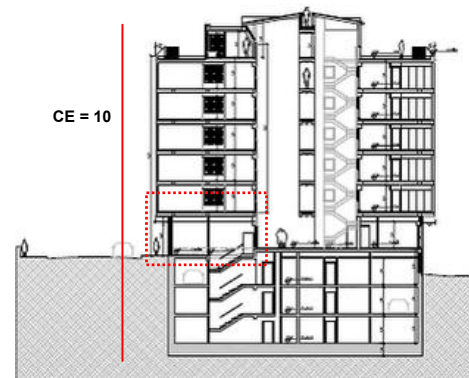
Esquema CE (edificio de 7 plantas + 3 sótanos) (Fuente: elaboración propia).
